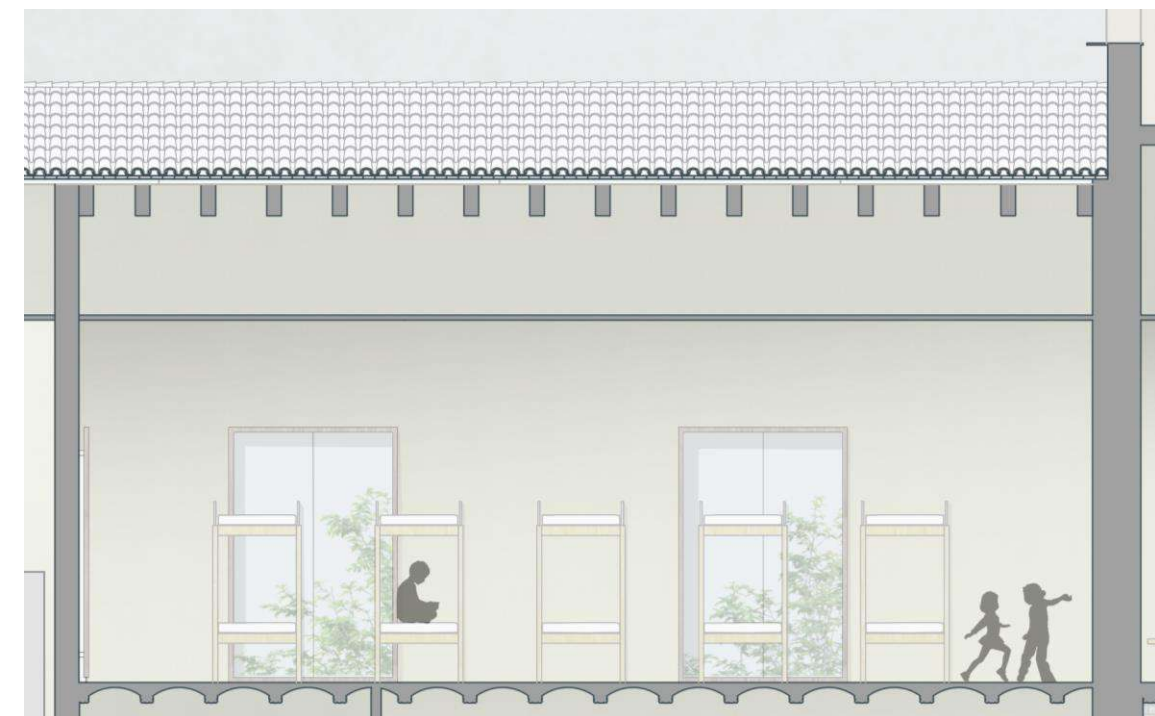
Plano de detalle de una de las habitaciones. Fuente: Elaboración propia
